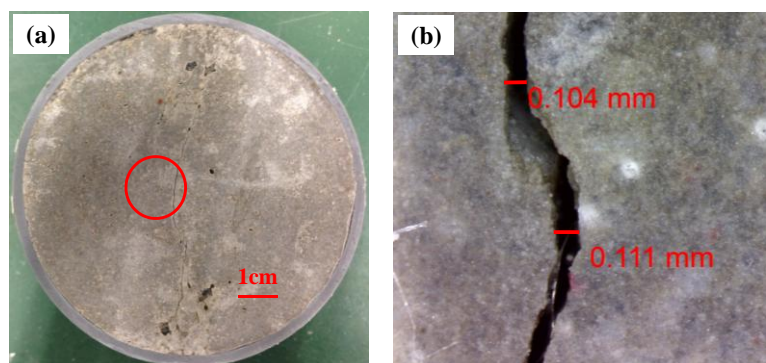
ひび割れ部の様子 (a) 供試体全断面 (b) ひび割れ部拡大
